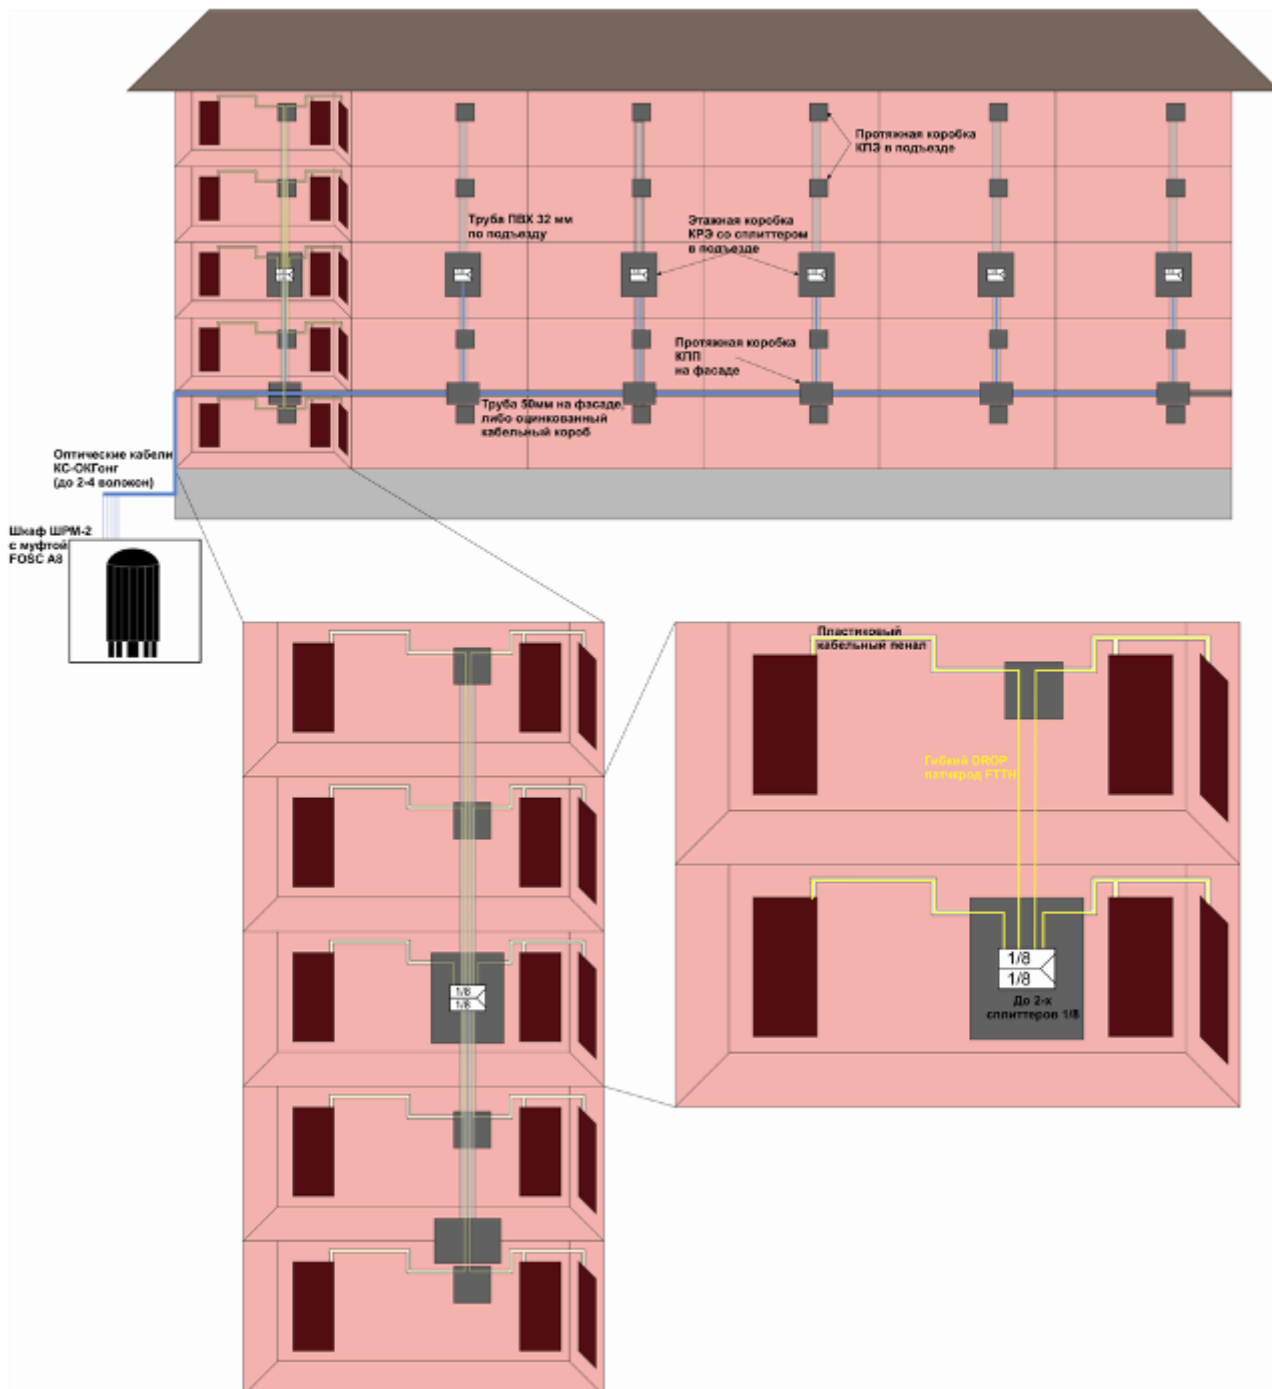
Схема размещения кабеля по зданию
